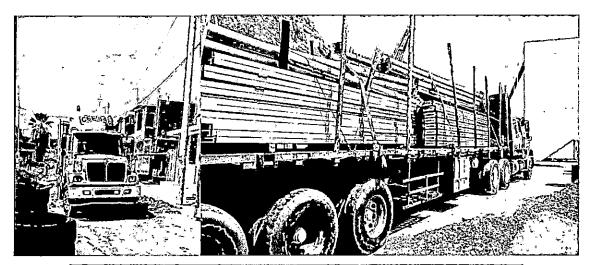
Ingreso de la estructura metálica en el DPA - Yacila.
